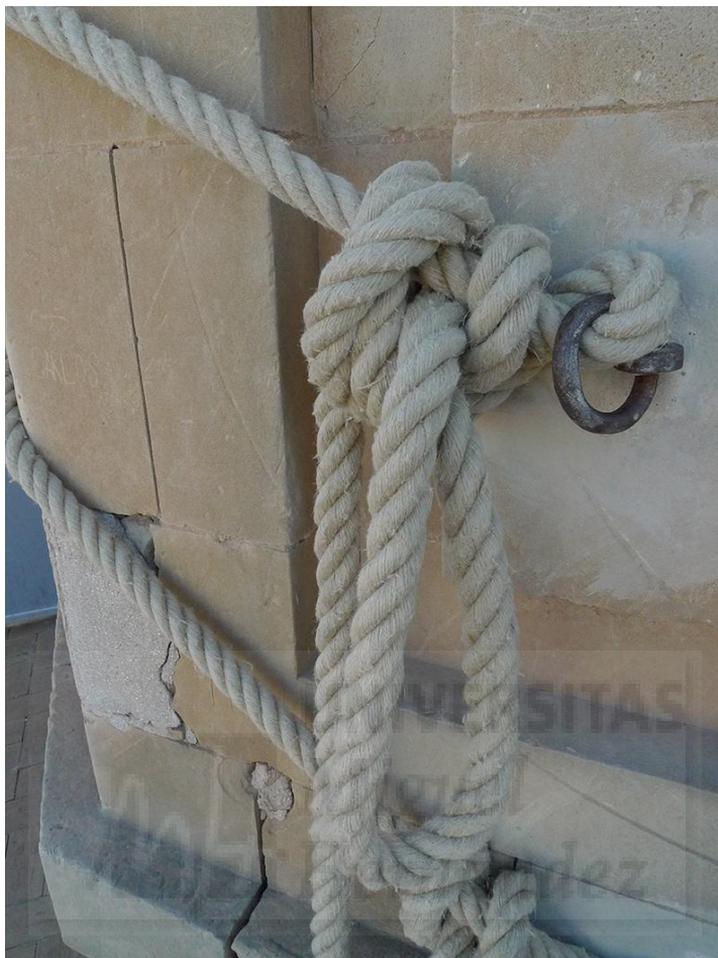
Atado de los dos primeros tirantes de los pilares de la cabria a las anillas de la cara del noreste.
